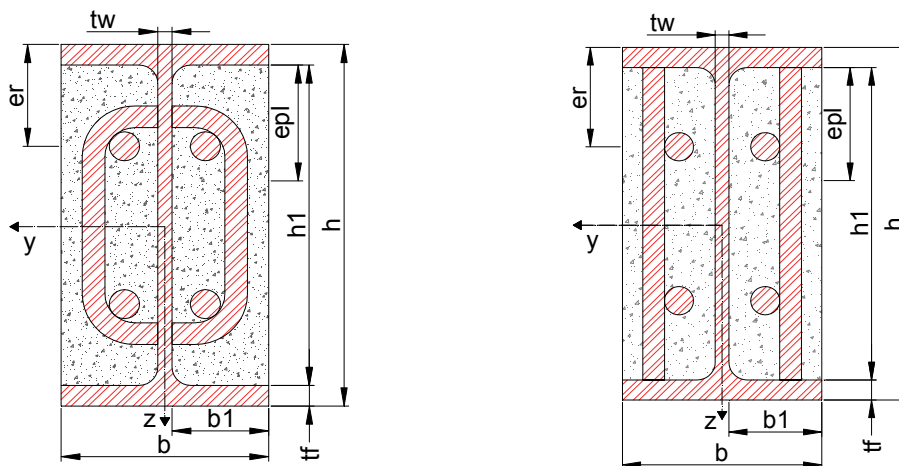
Geometria de secções PEBA e PEBB da viga
